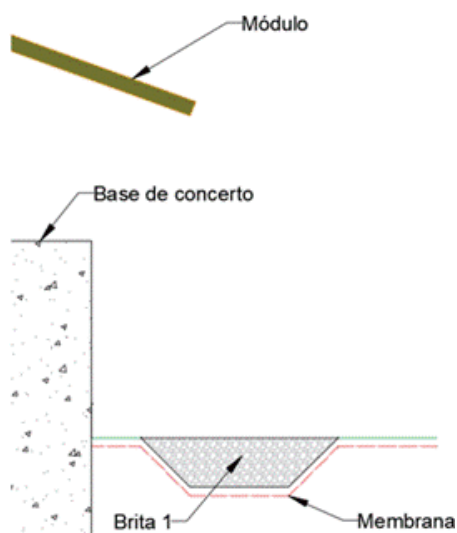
Esquema construtivo orientativo de calhas para drenagem de água pluvial do plano dos módulos FV.
